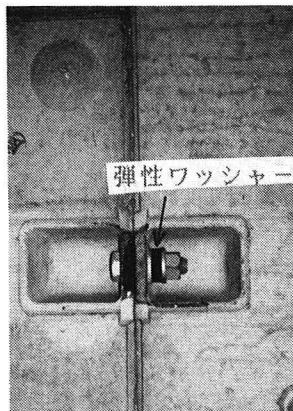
弾性ワッシャー 写真-2 可とうセグメント
